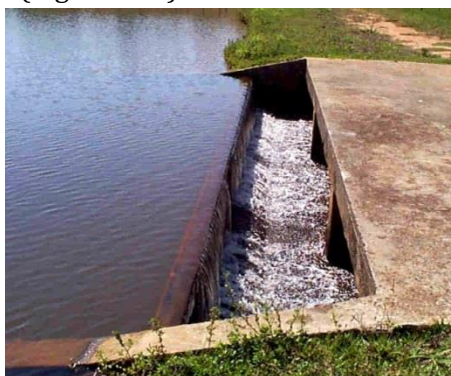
Vertedouro de barragem construída para atender demandas de irrigação.
